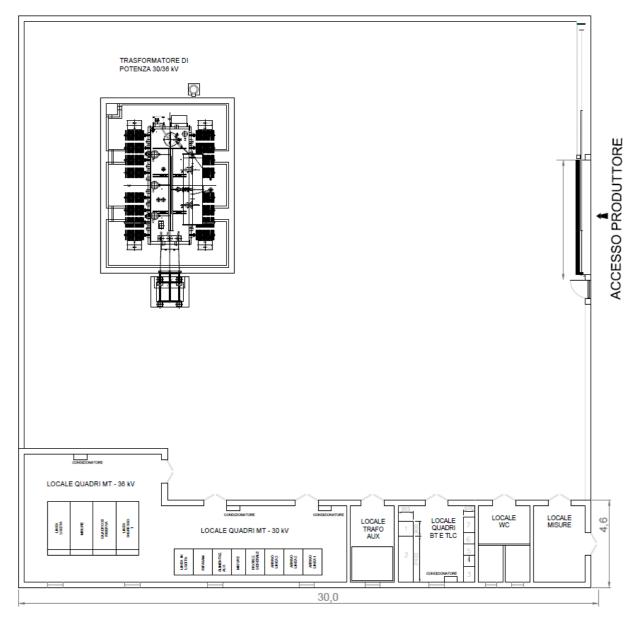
Planimetria elettromeccanica della stazione utente di trasformazione 30/36 kV
